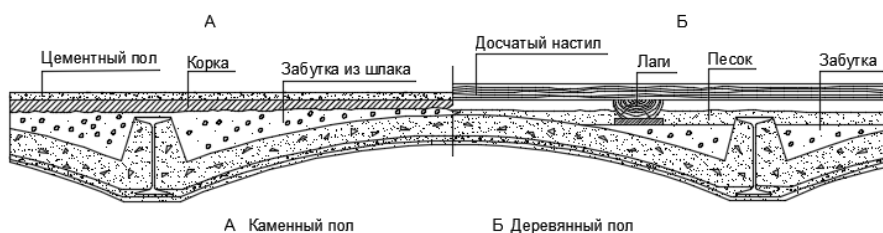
Междуэтажное перекрытие по металлическим балкам
